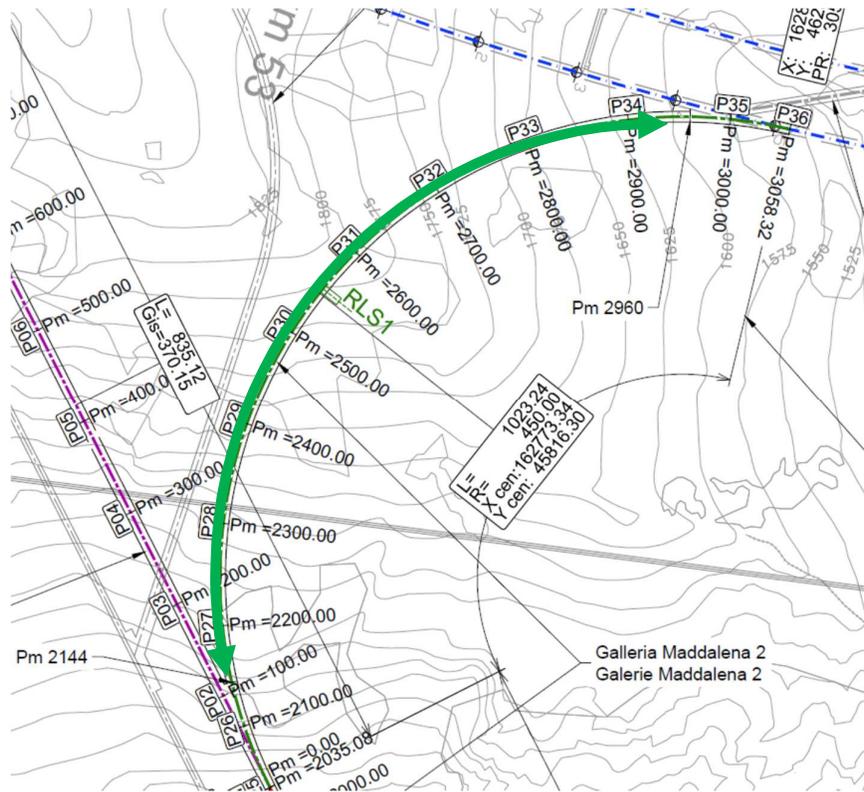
Planimetria delle zone di stoccaggio in Maddalena 2 (PRV_C3A_7520_26-48-11)
